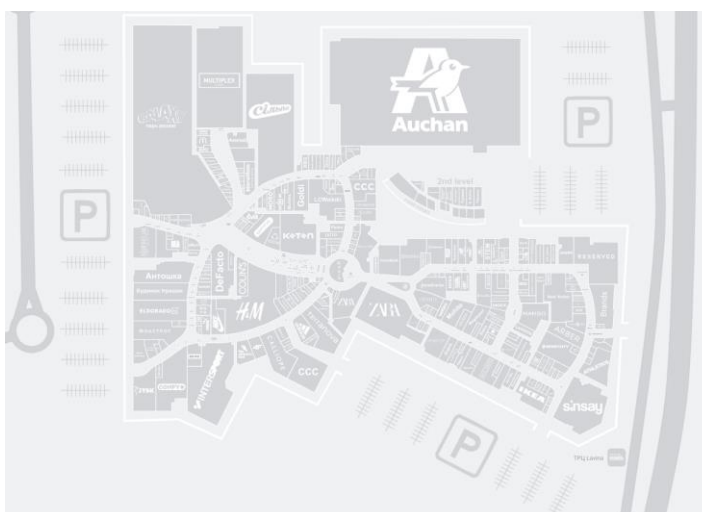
генеральний план ТРЦ «LAVINA MALL» [10]
